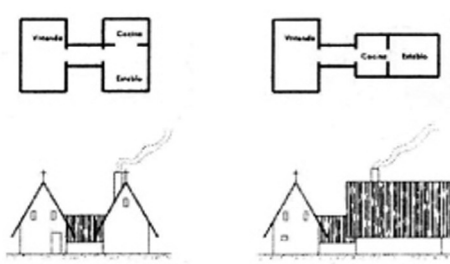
Plantas y alzados de barracas según Casas Torres. (Del Rey, 1998: 162)
